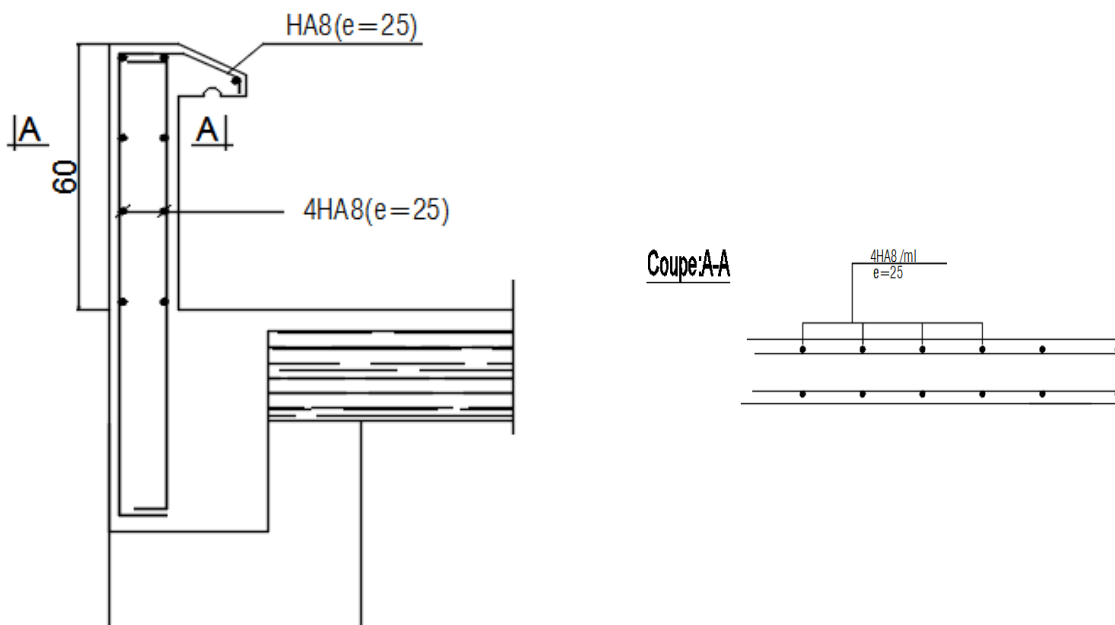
Plan de ferrailage de l'acrotère.
